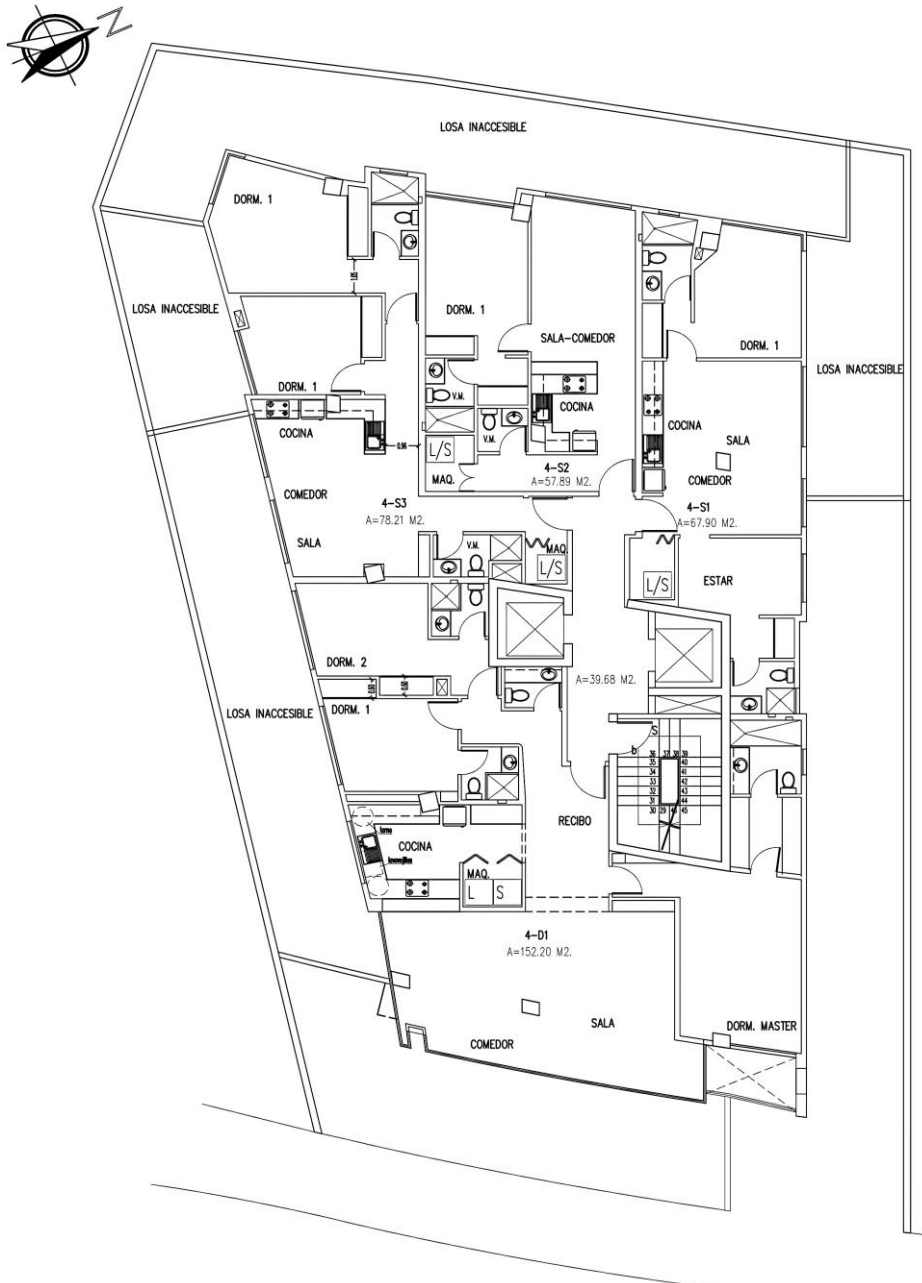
Planos Arquitectónicos Edificio Bohème – Planta 3, 4,5
